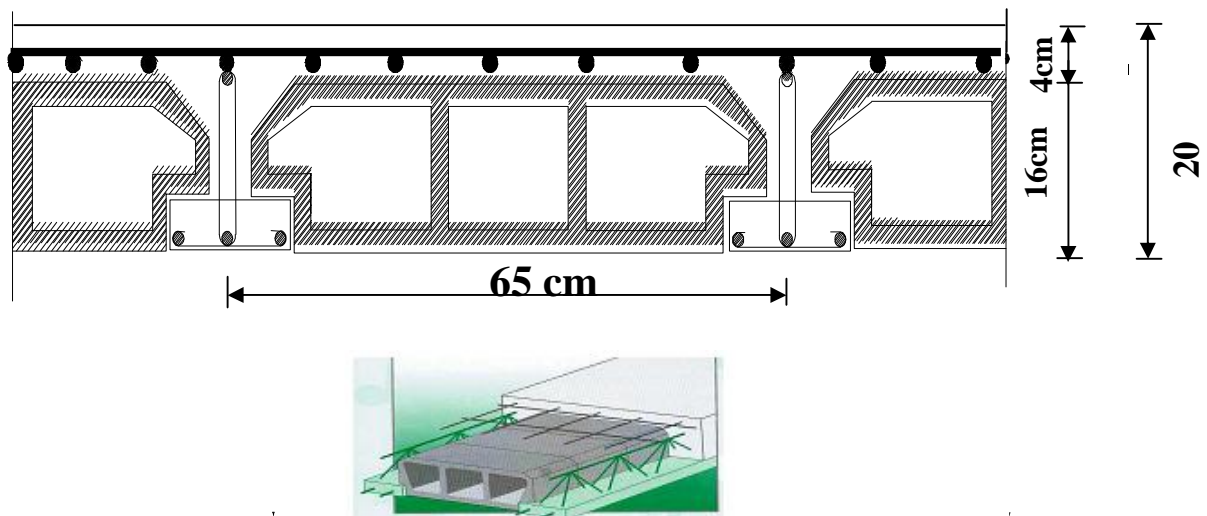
Coupe transversale d'un plancher en corps creux.
